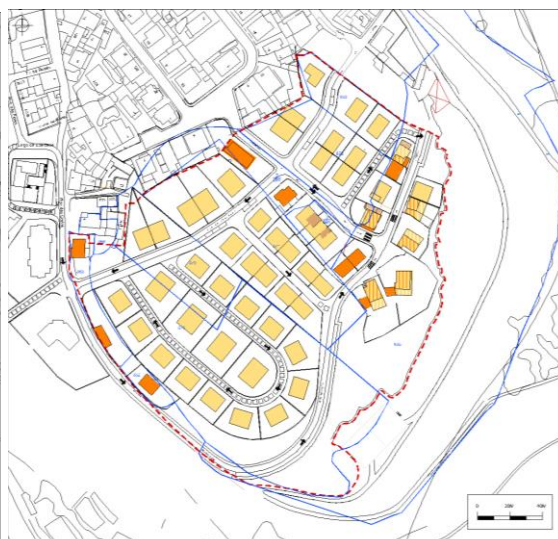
Planta com a junção dos projetos de loteamento da fase 3 concluídos em 2016. Fonte: CMO/DPE
